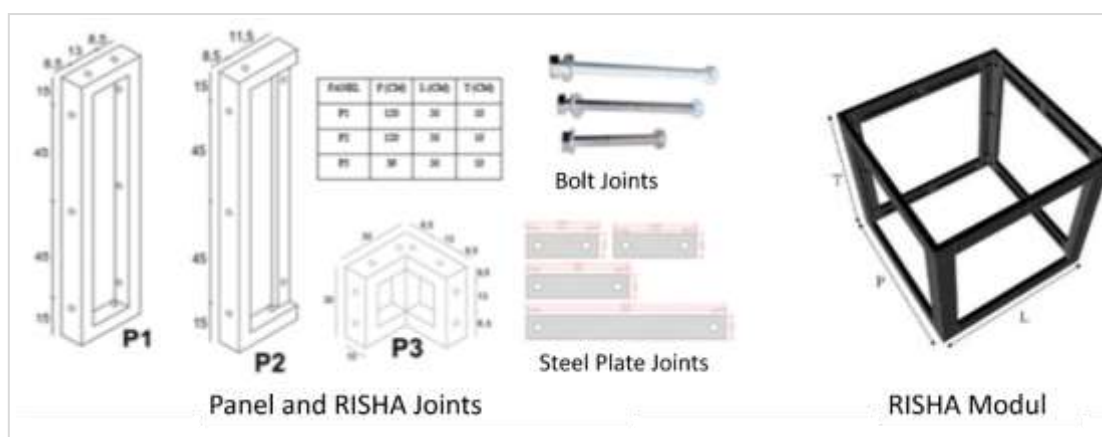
Structural components of RISHA: Panel 1, 2, dan 3
